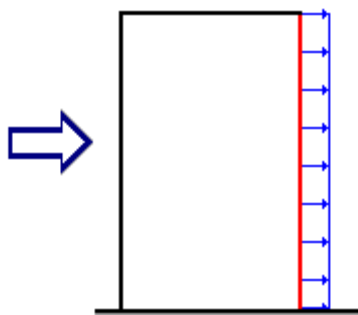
Расчетная схема определения ветровой нагрузки на подветренную поверхность.
